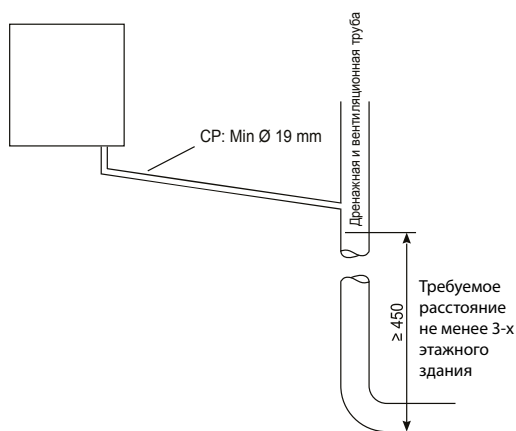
Подсоединение дренажной трубы для конденсата к внутренней дренажной и вентиляционной трубе
